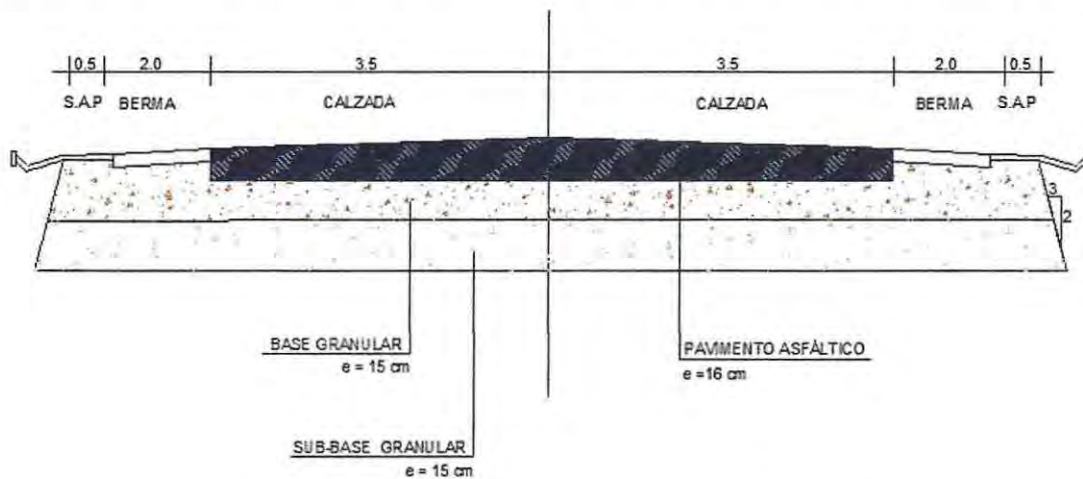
Esquema de la estructura de pavimento flexible, caso N°2
